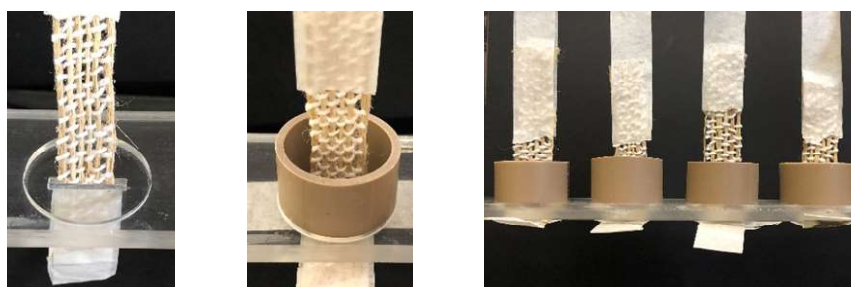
Moldagem de corpos de prova para ensaio de arrancamento dos feixes.
